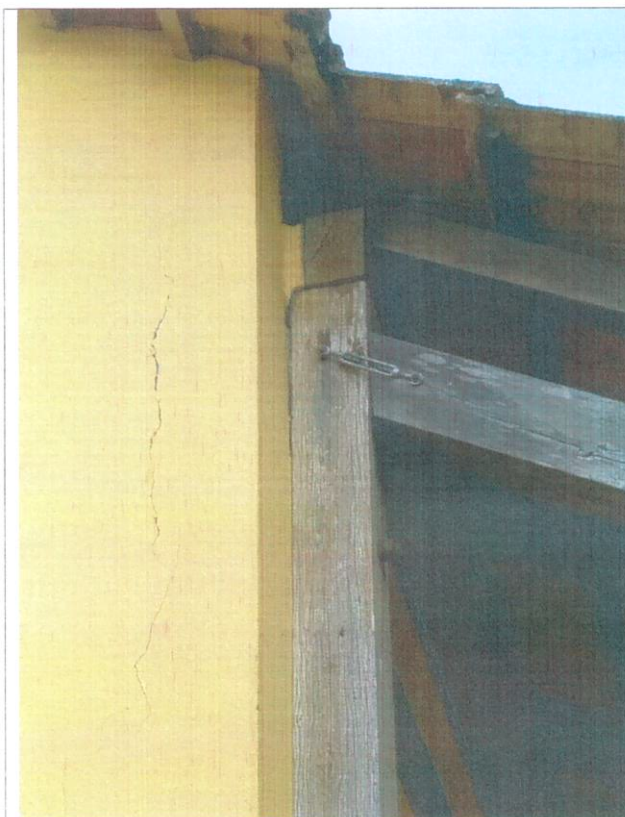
Fissura na parede onde está parafusado o apoio do mezanino e a cobertura da área de embarque. Pilarete afastou-se da parede.
